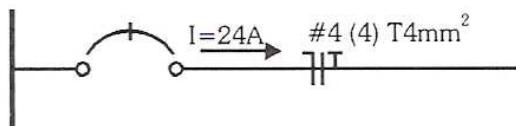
Exemplo de dimensionamento de dispositivo de proteção.
